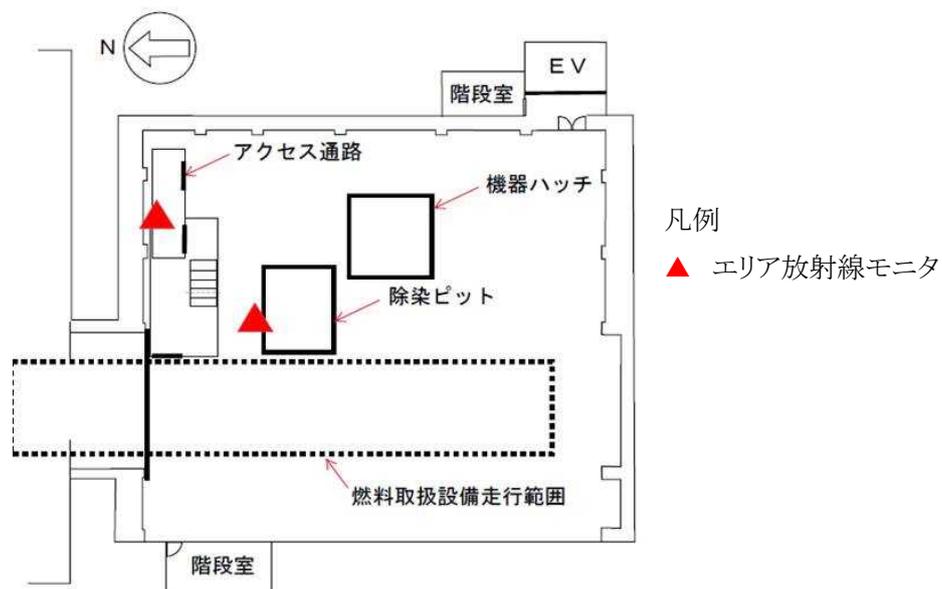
2号機燃料取り出し用構台内のエリア放射線モニタ配置図
